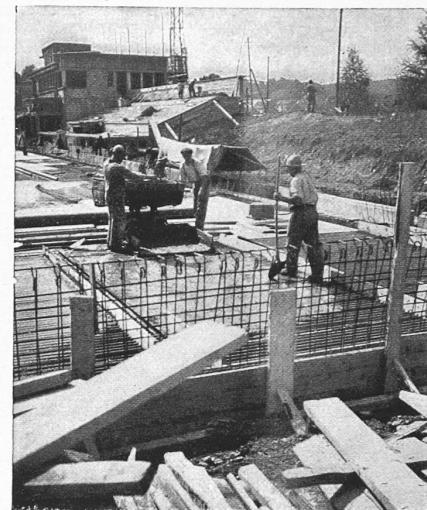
Einbetonierung der Gefrierplattenrohre.
